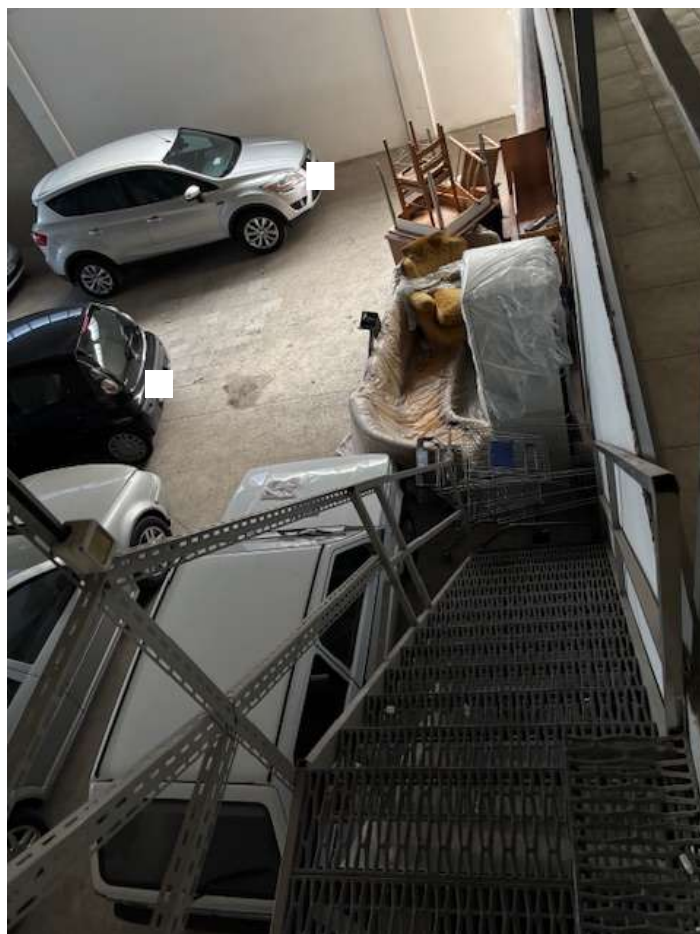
Scala di accesso indipendente al primo piano, direttamente dal piano terra
